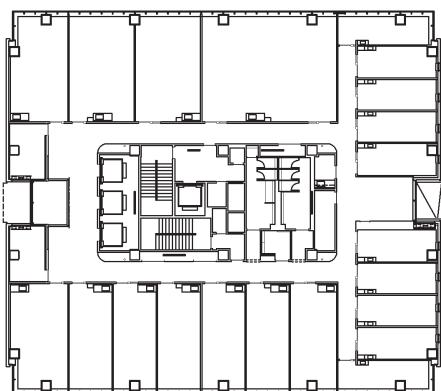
(2) 高層棟平面図（地上 6 階～地上 11 階）(2/3)
